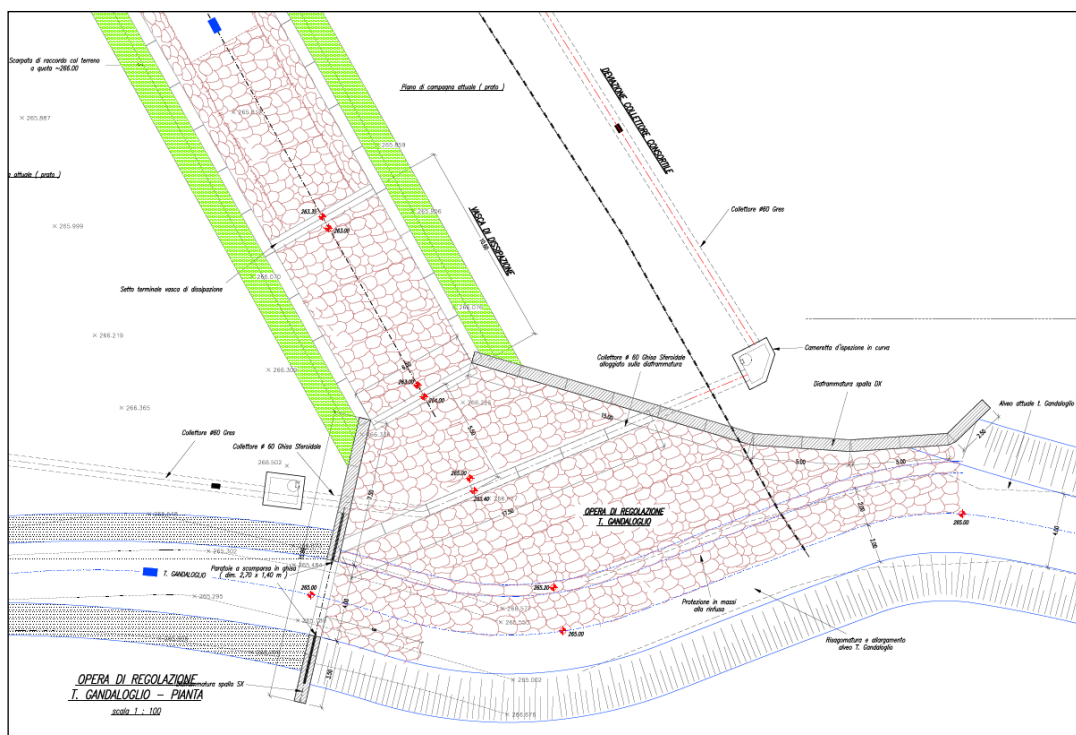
Vista in pianta dell'Opera di regolazione (Progetto Esecutivo Lotto 1)
